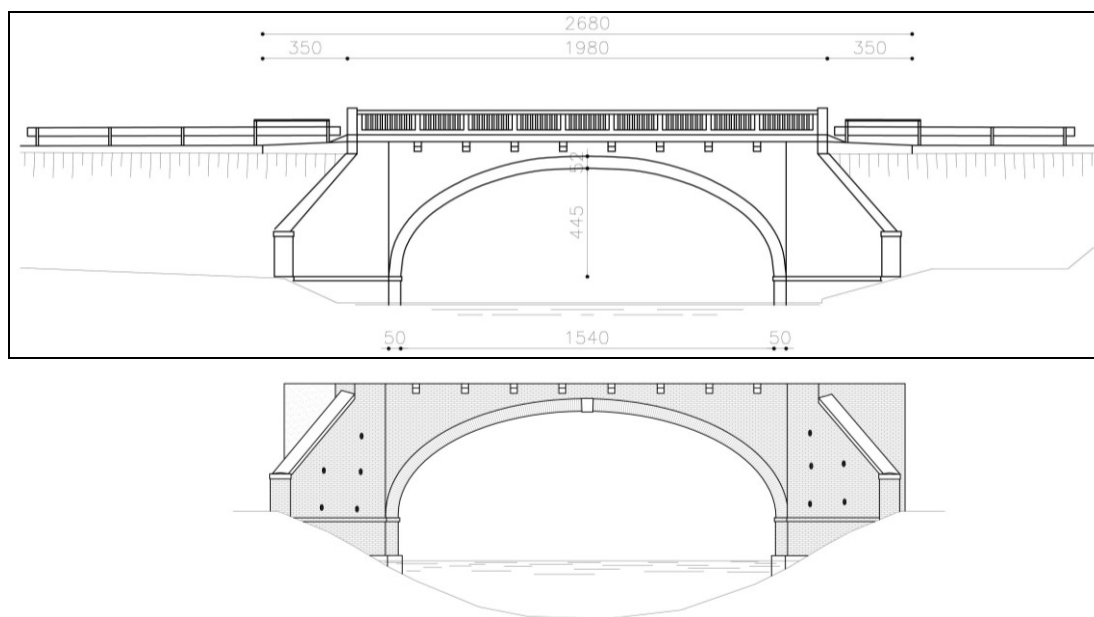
Prospetto sud del ponte. Vista quotata e vista solo muratura
